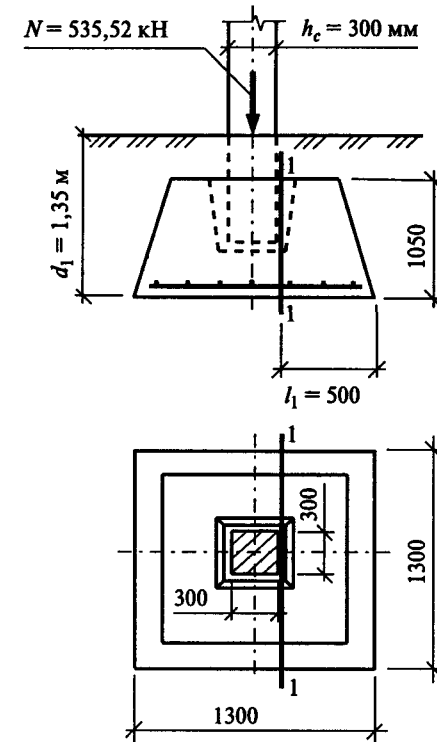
Расчетное сечение фундамента – к примеру 12.3
